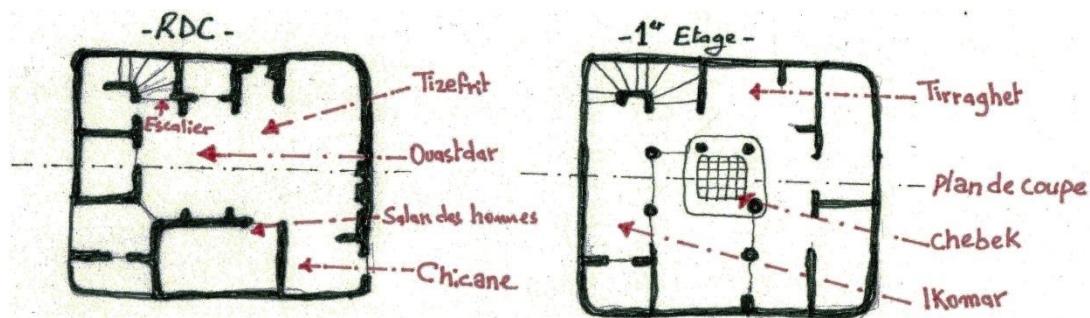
Coupe d'une Maison M'Zab.
